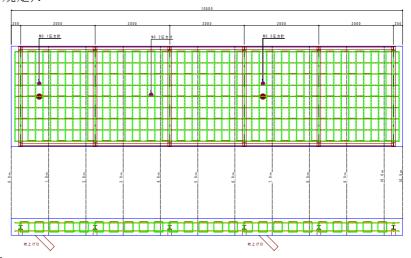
モデル型枠の形状・配筋詳細図(単位:mm)
